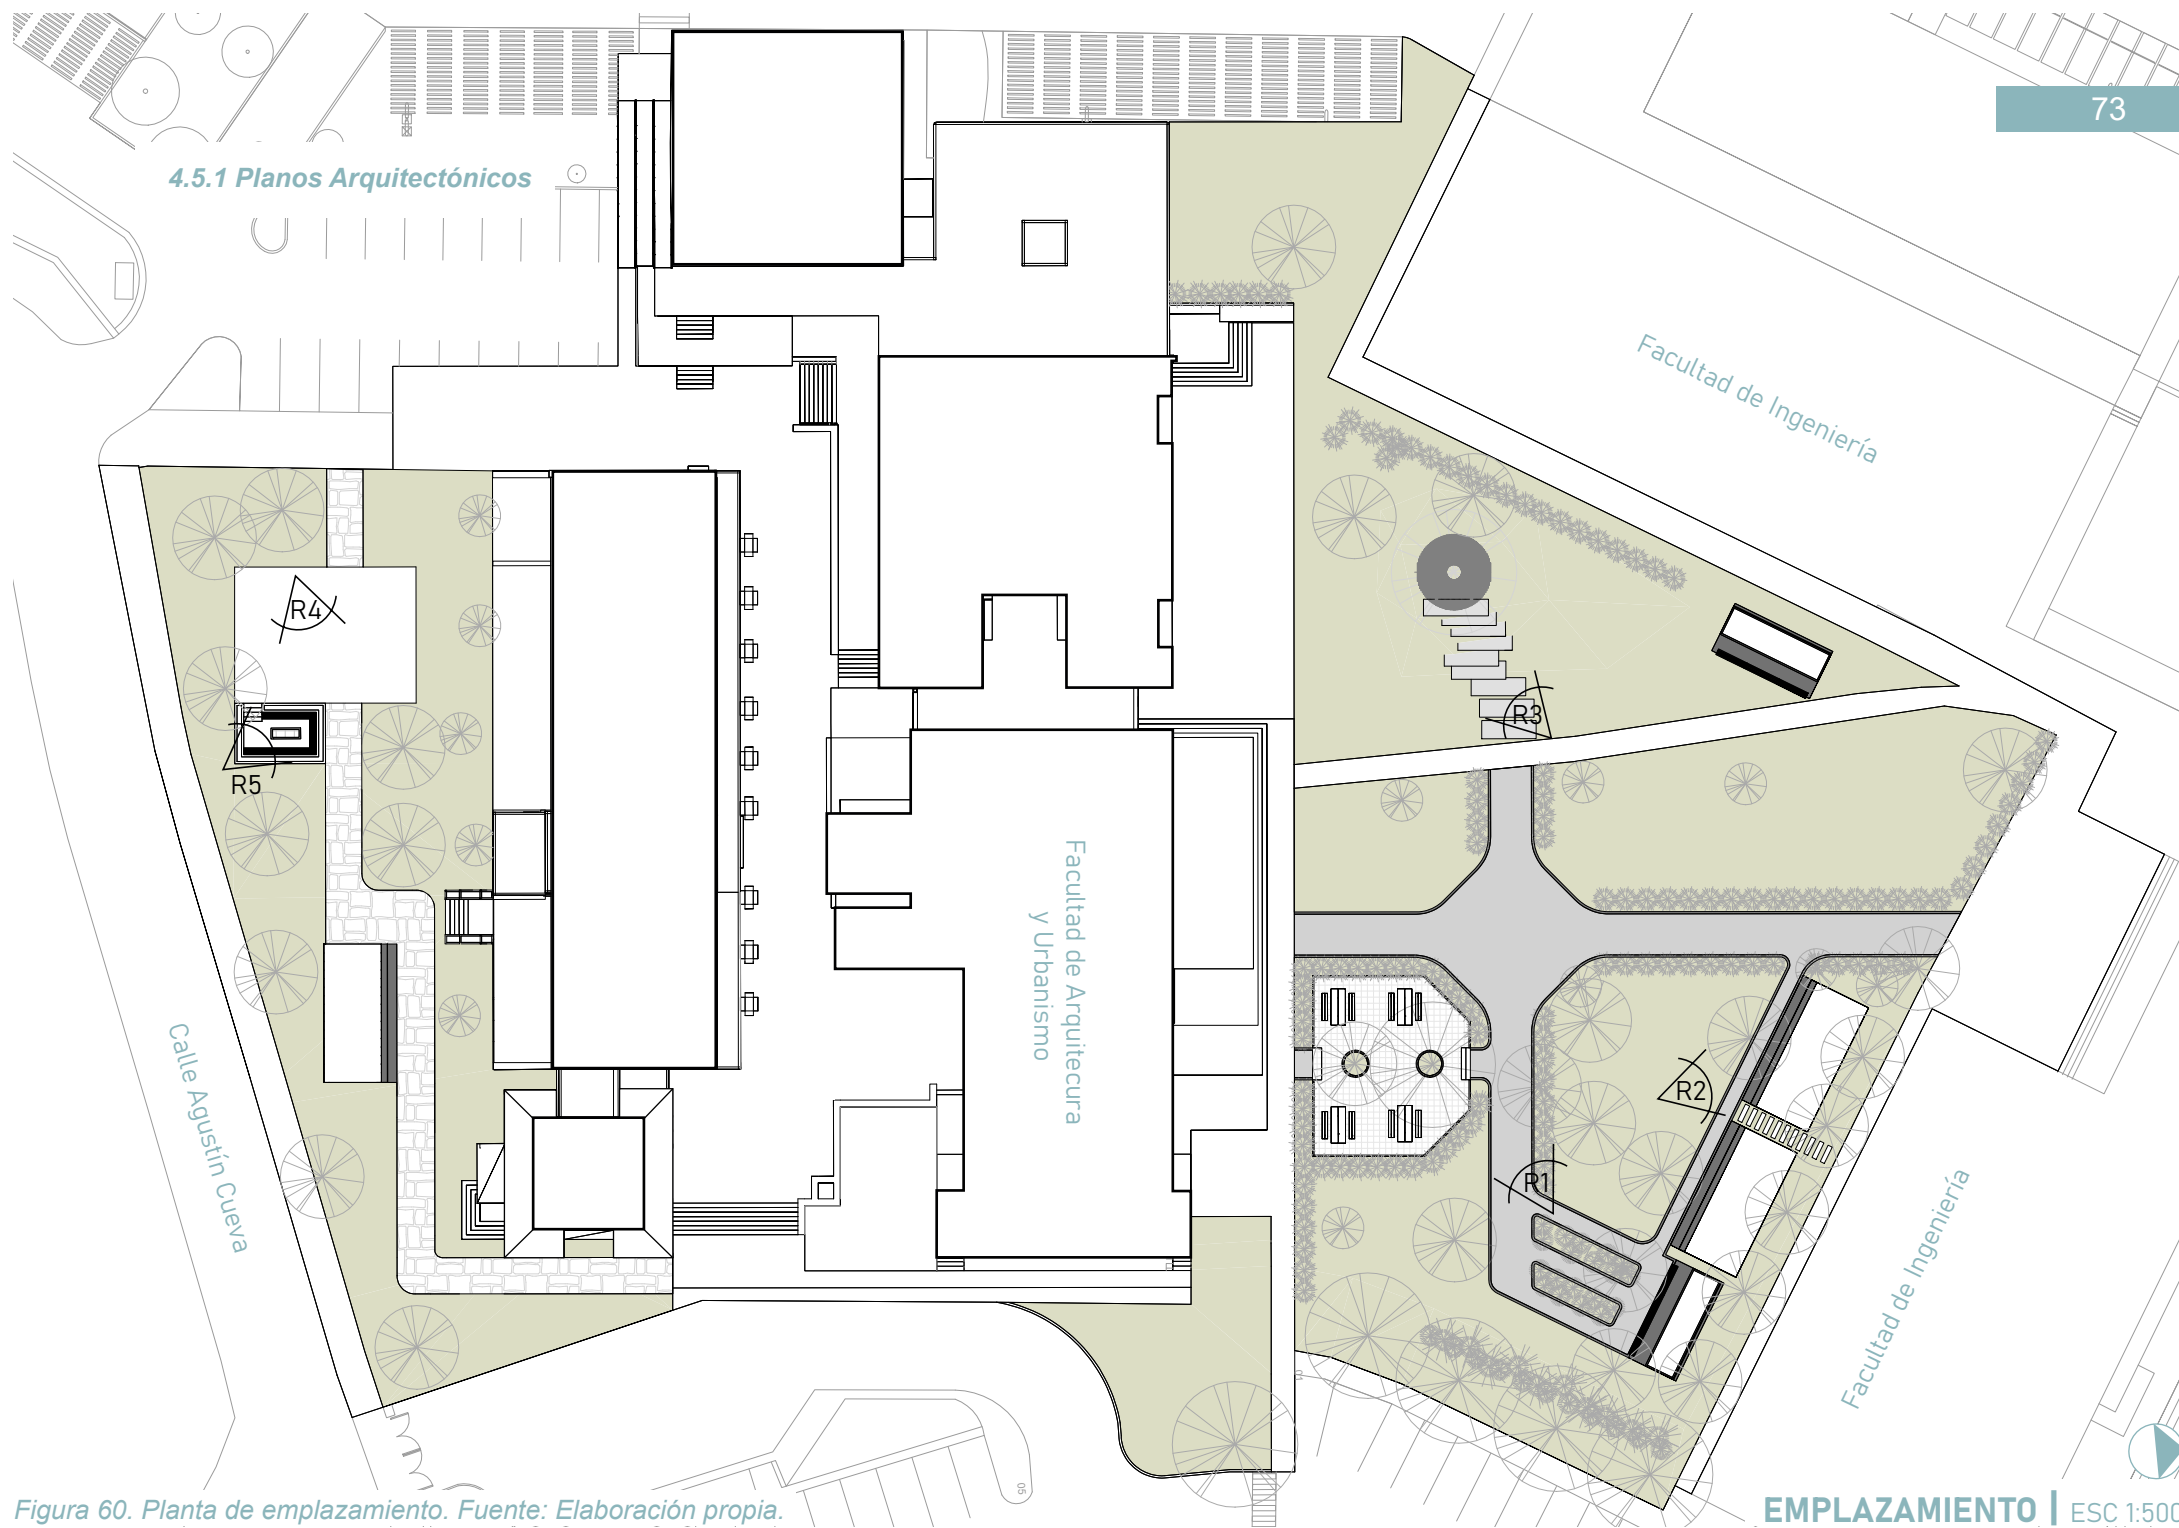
Planta de emplazamiento. Fuente: Elaboración propia.
